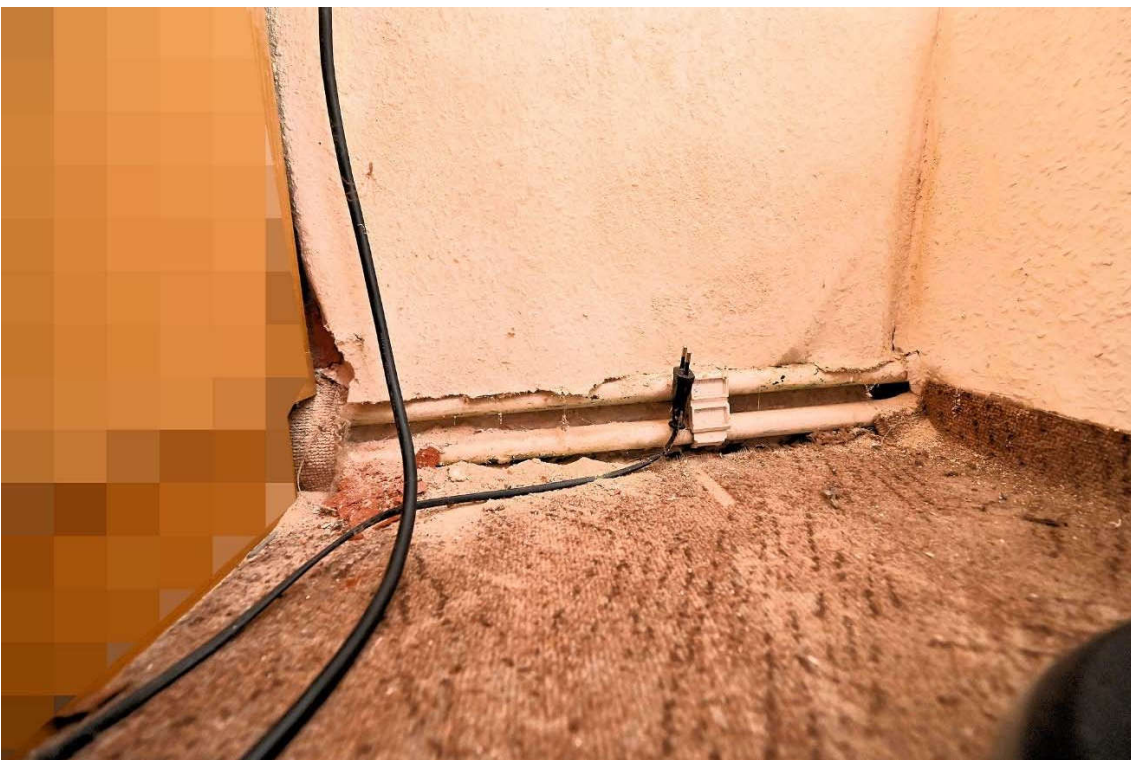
Gebäude A, Erdgeschoss, Wohnzimmer, Detail Nässeschaden u. a. Außenwand / Zimmer 2
